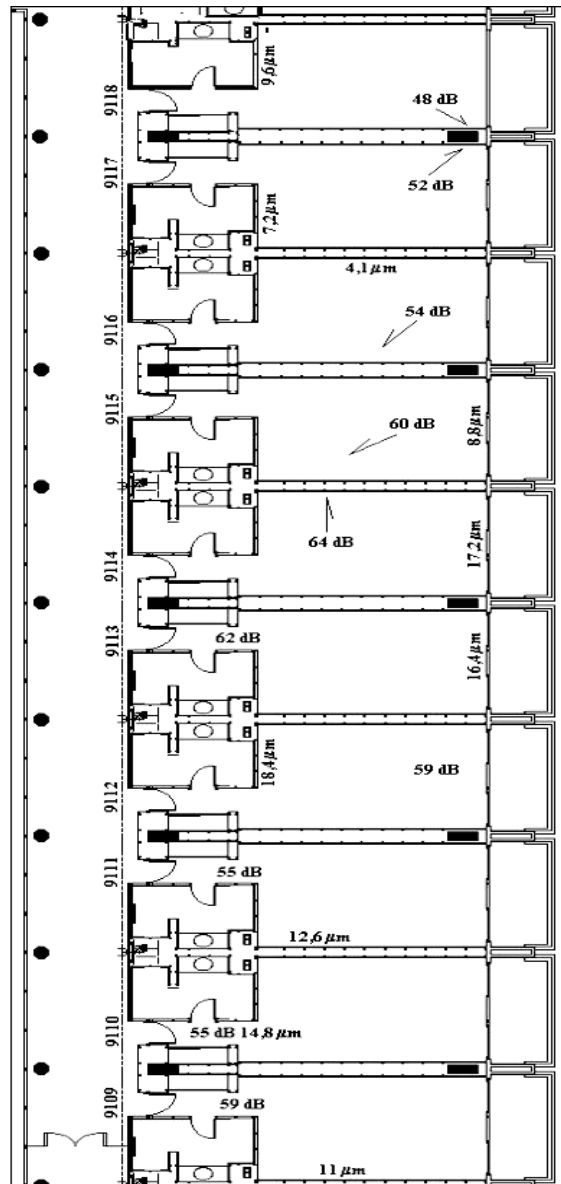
Vista en planta de las habitaciones afectadas acústicamente.
